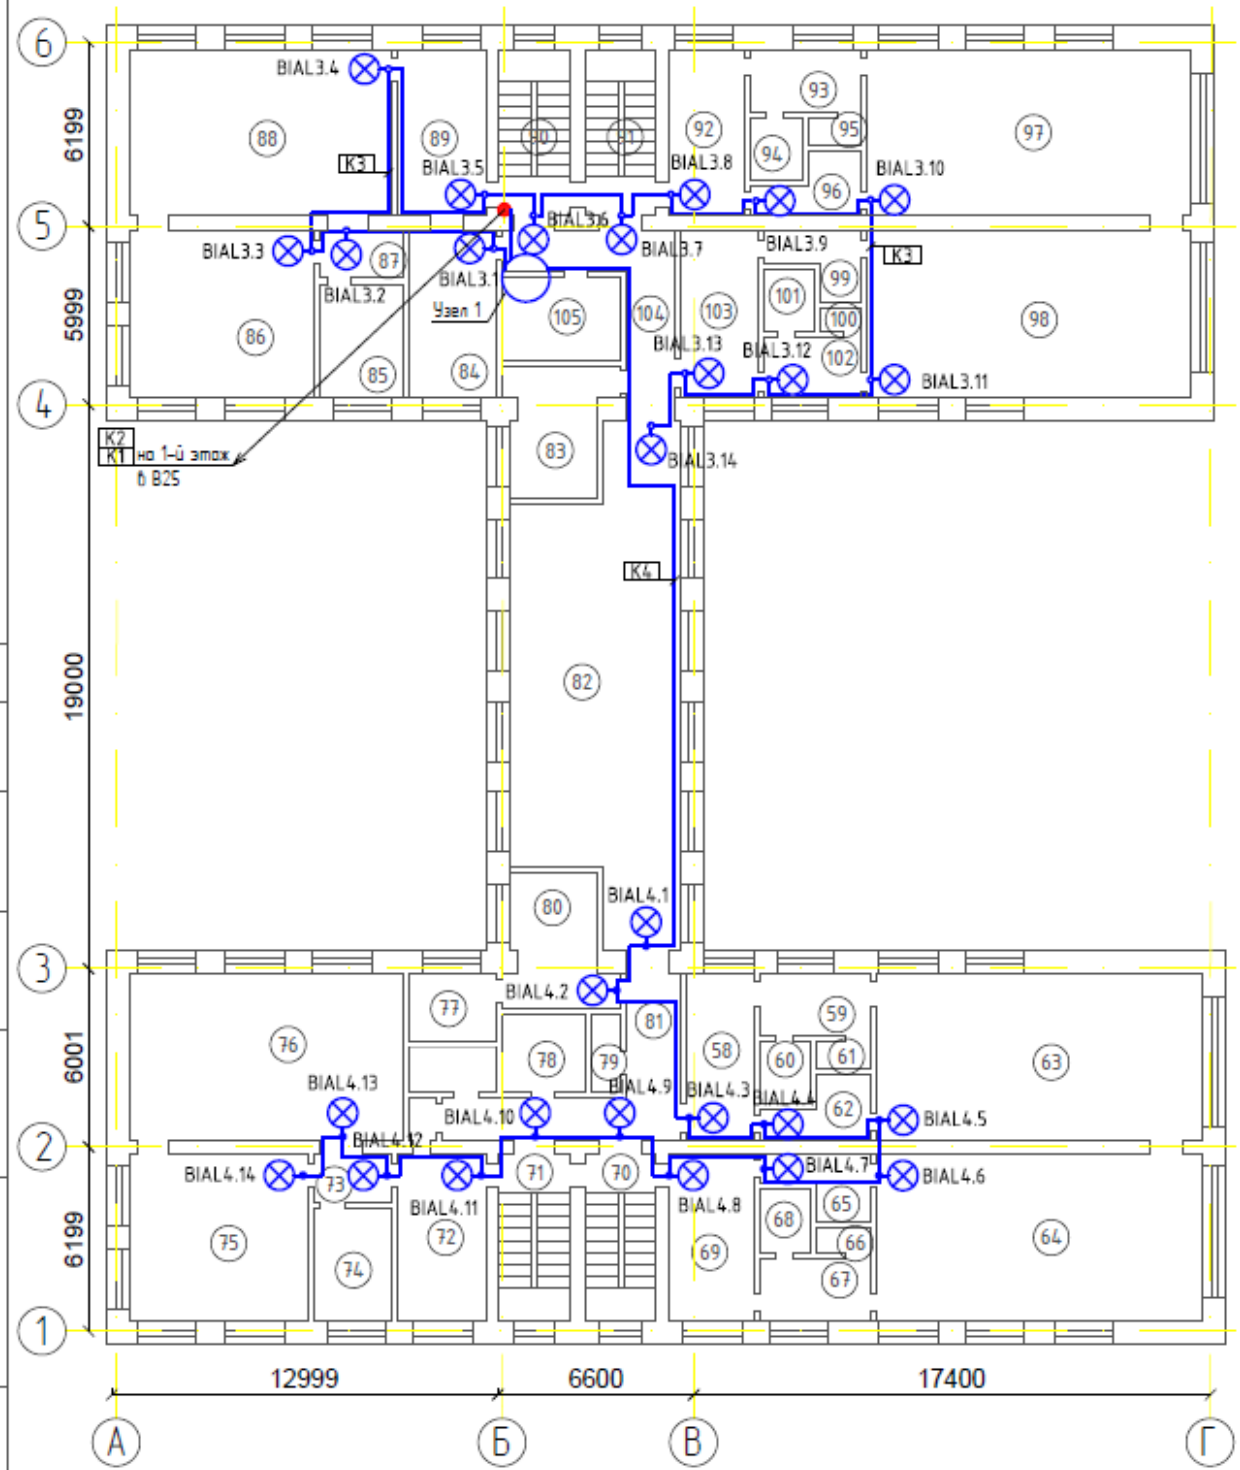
План 2-го этажа сети светового оповещения о пожаре
